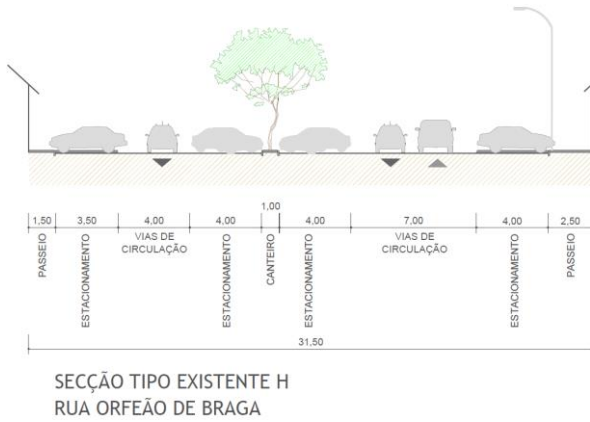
Secção tipo existente H - Rua Orfeão de Braga
